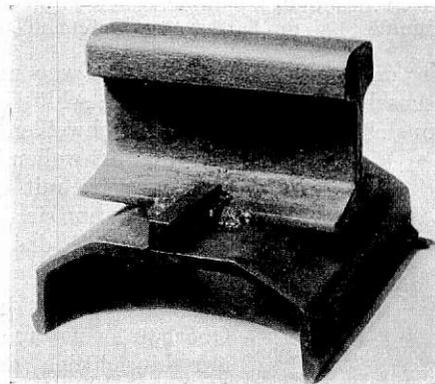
Geschweißte Schienenverbindung mit Sicherheitshaken auf Eisenschwelle.
